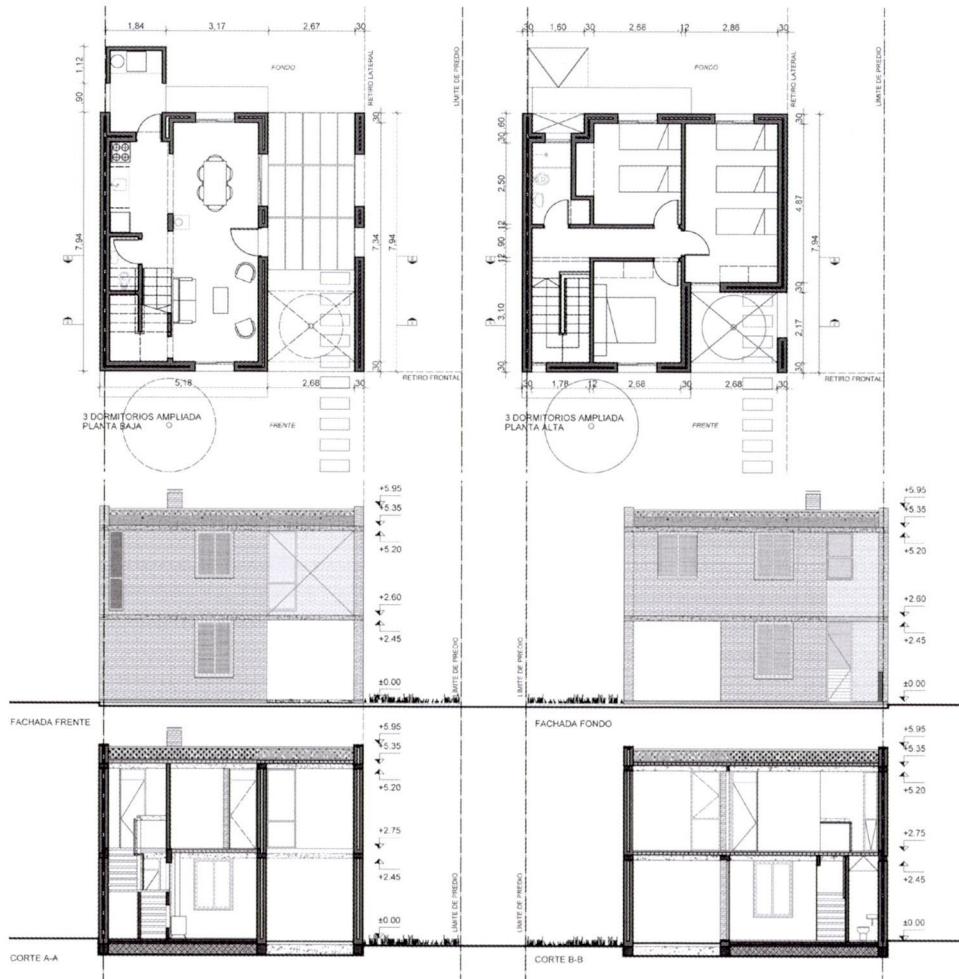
Plantas, cortes y fachadas de las viviendas de 3DA.
